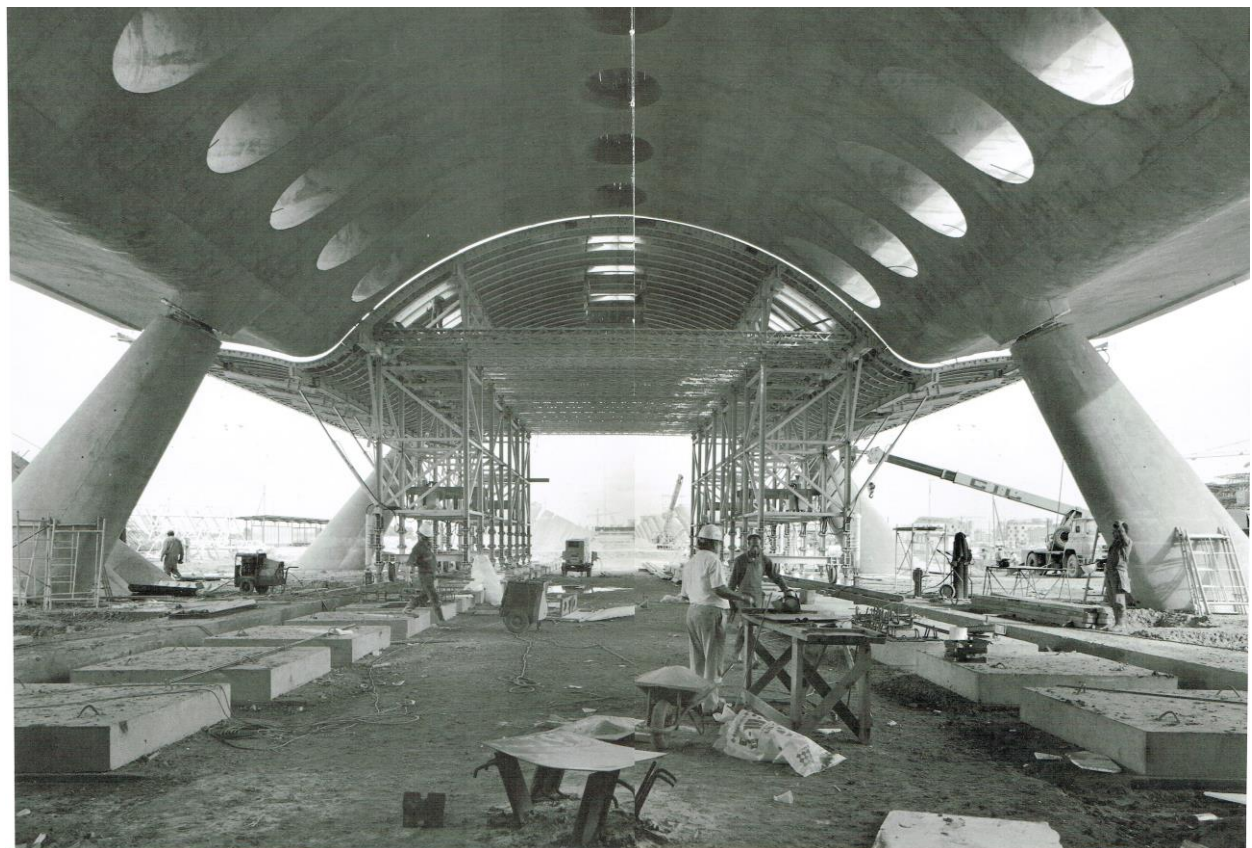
Proceso constructivo viaducto, cimbra trasladable.
